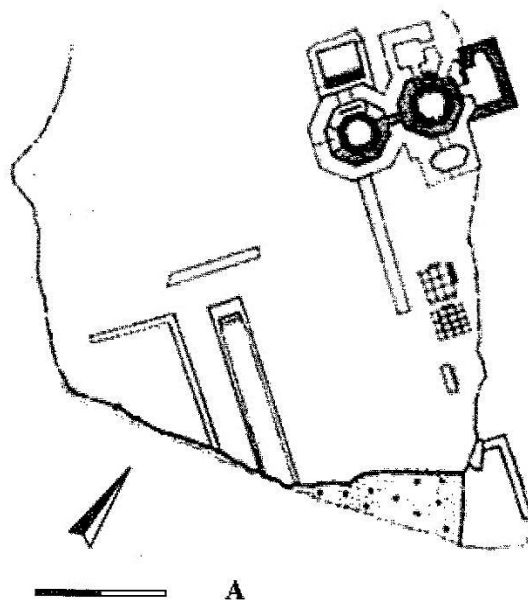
Planimetría de la villa de Torreblanca del Sol (Marbella).
